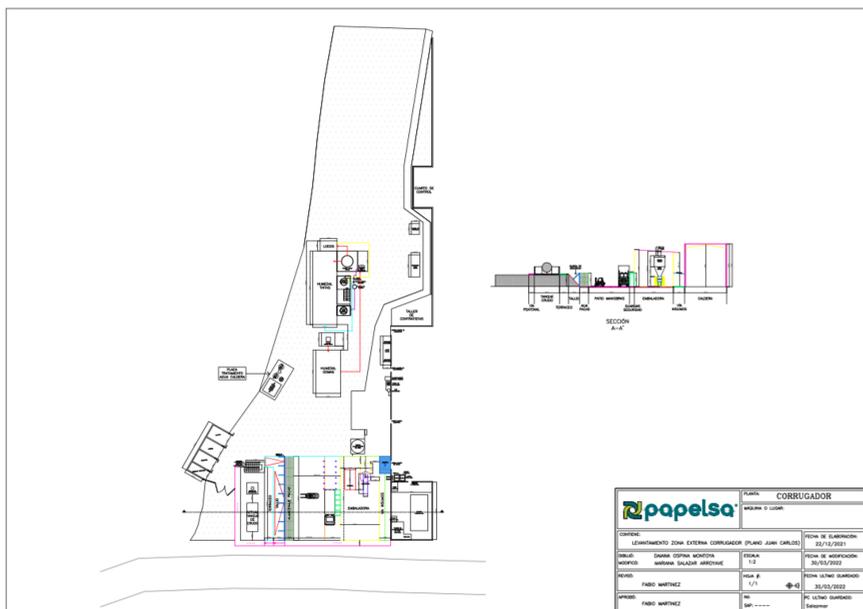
Plano Zona externa Planta corrugador (esquema para presentación)
